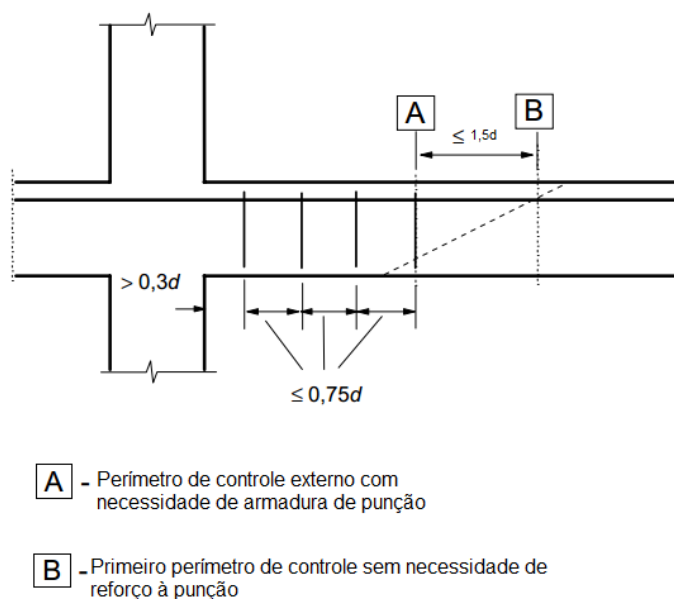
ESPAÇAMENTO NECESSÁRIO PARA AS ARMADURAS DE PUNÇÃO
